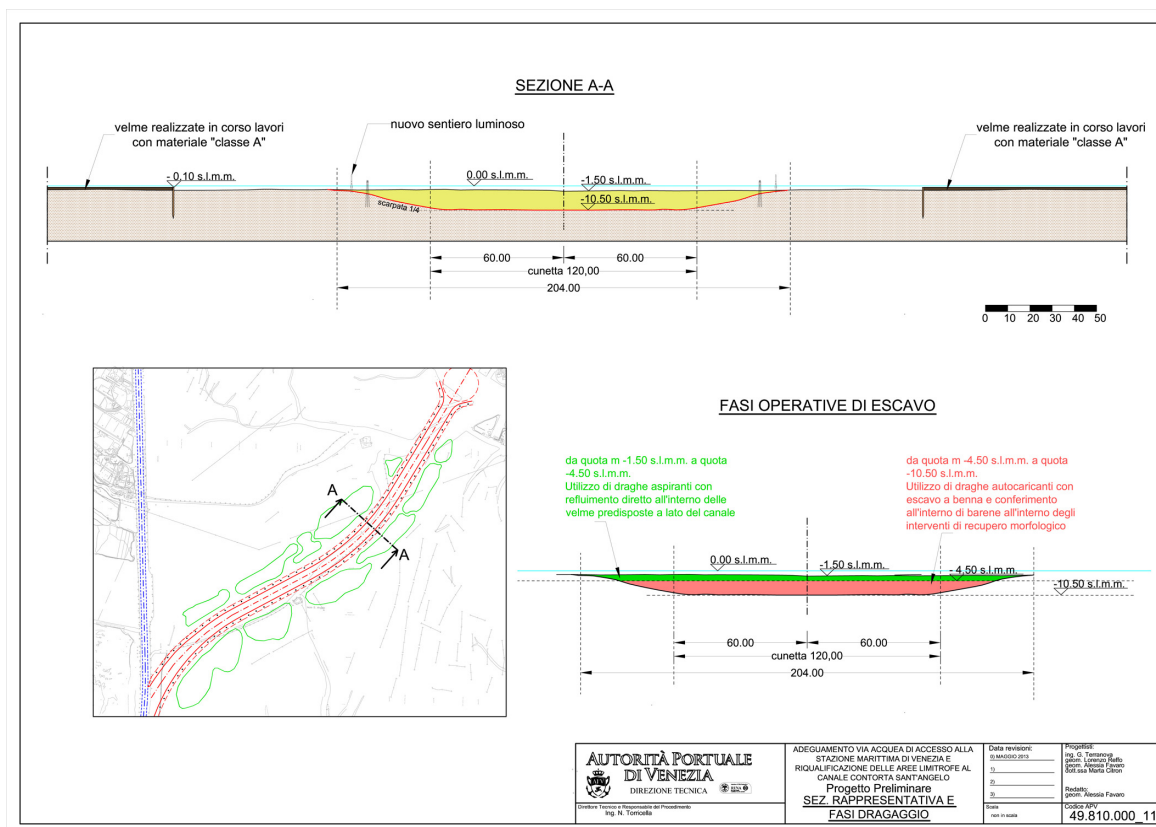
Sezione tipo del progetto del canale Contorta Sant'Angelo.
